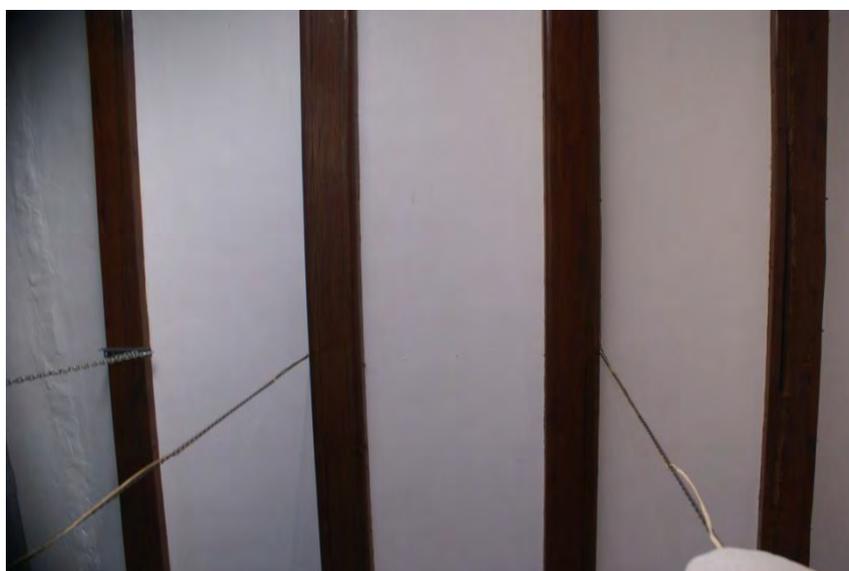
Vivienda en c/Mayor, 37. Cubierta inclinada y pilares de ladrillo.
